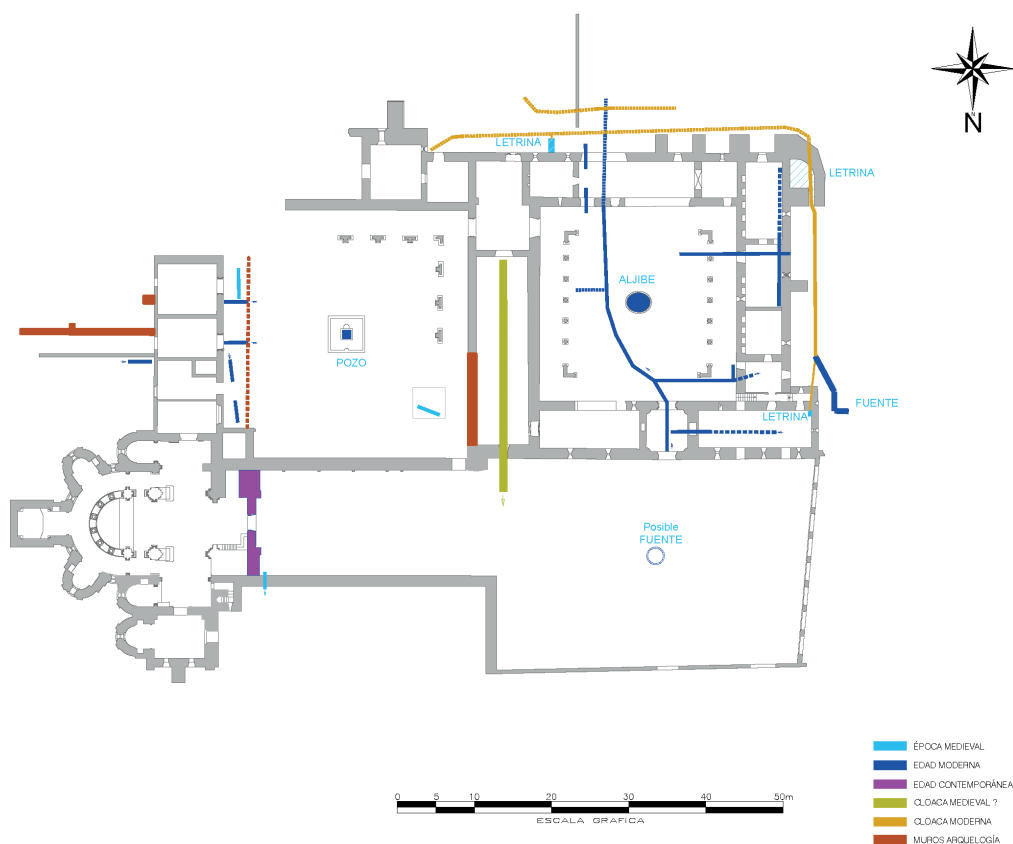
Estructuras hidráulicas del monasterio de Melón, exhumadas arqueológicamente entre 2002 y 2018, reunidas por F. Miguel (2022). Planimetría de José Carlos Láiz.
